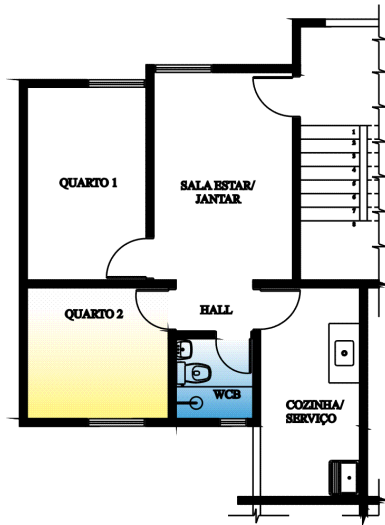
Planta Baixa Pav. Tipo do Residencial Morada das Artes (sem escala)
